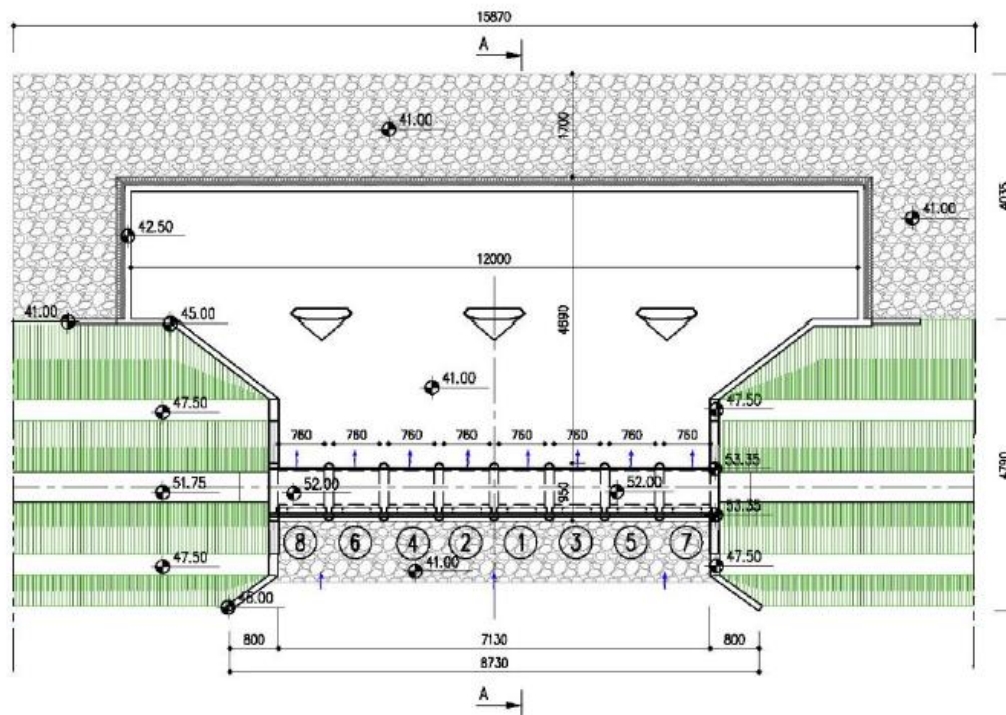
Veduta in pianta del nuovo manufatto di collegamento con la cassa laterale.
